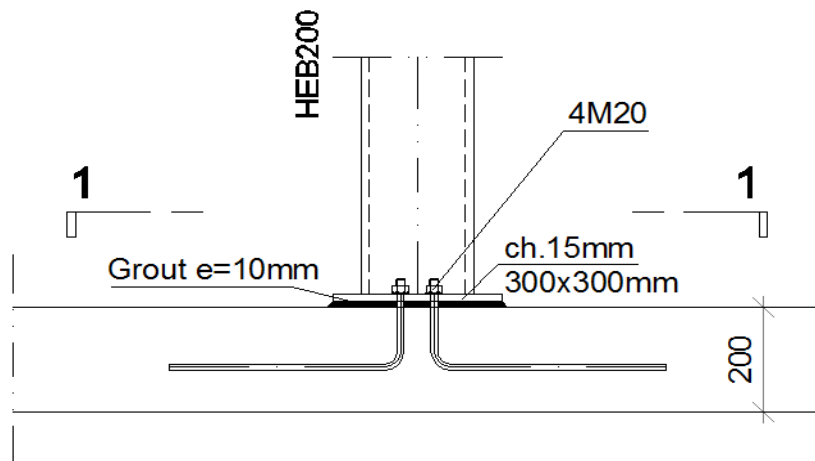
PORMENOR DA LIGAÇÃO MISTA (HILTI PROFIS ANCHOR)
